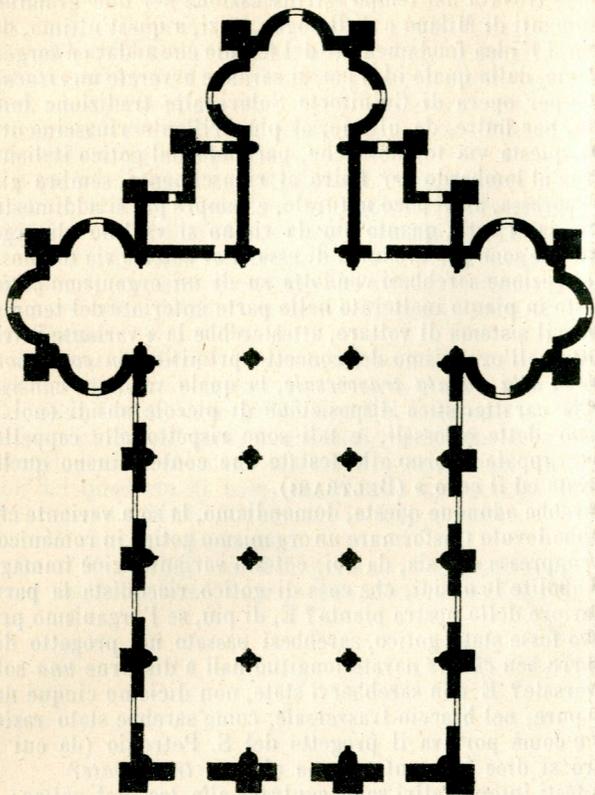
Pianta ipotetica secondo il primo concetto di stile lombardo.
